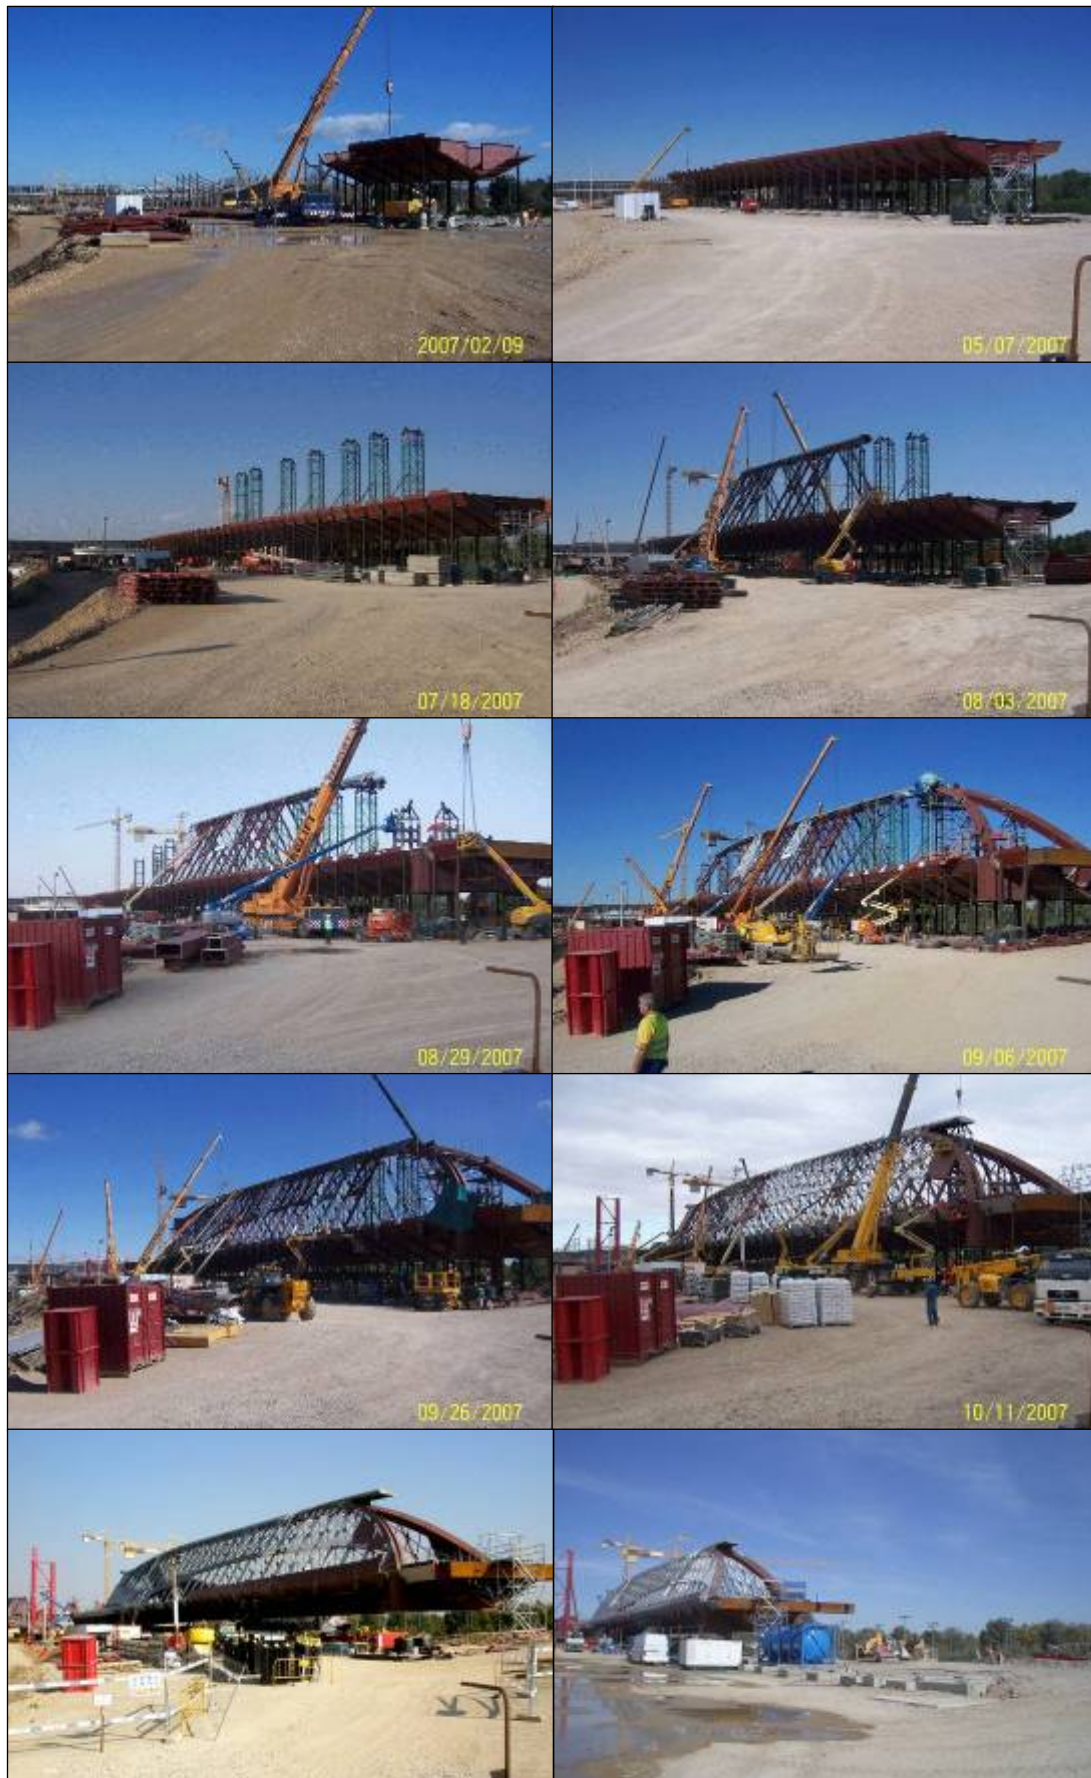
Fig.XX Secuencia de construcción del vano sur. 1 Apeos provisionales. 2 Montaje del cajón y diafragmas interiores. 3 Colocación de torres de apeo para el montaje del cordón superior. 4 Colocación de costillas y paneles de fachada.
